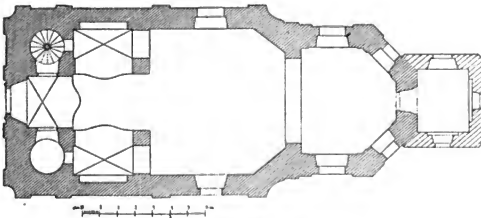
Prívětitz. Grundriss der Kirche.
